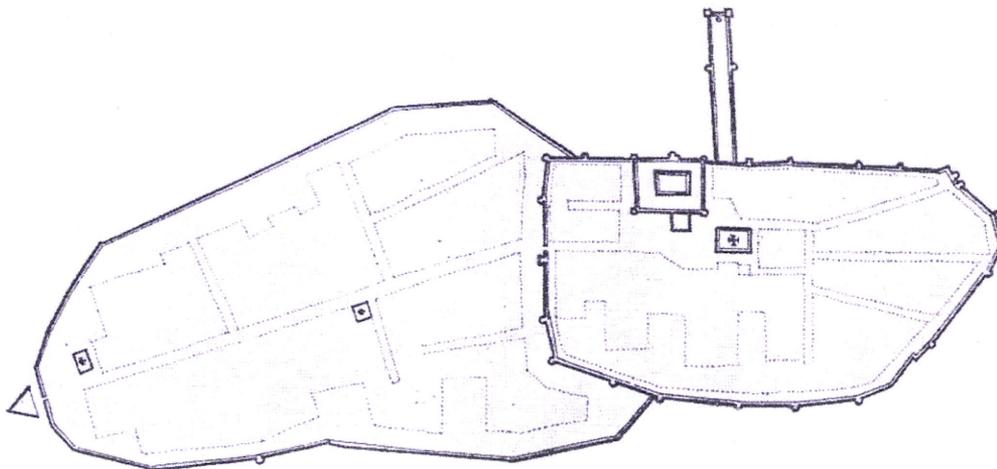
Planta do Castelo de Estremoz, da autoria de Nicolau de Langres (1644-1660)
